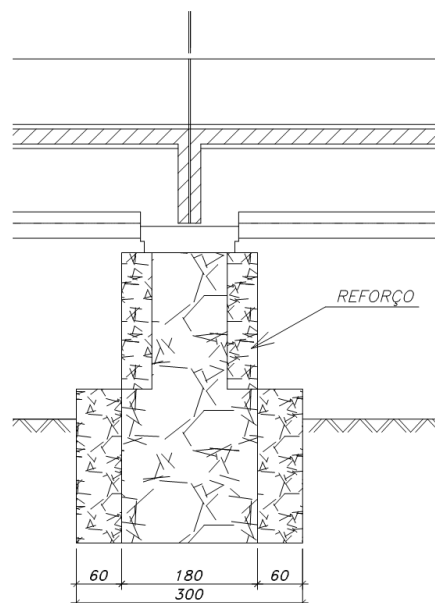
Seção transversal do pilar-parede central após o reforço.
